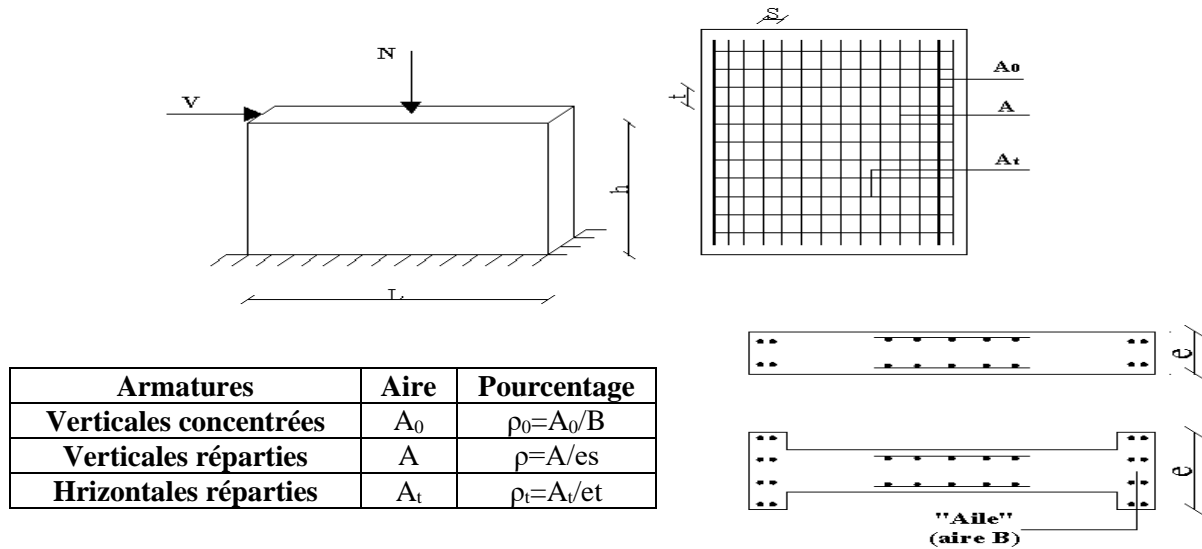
Schéma d'un voile plein et disposition du ferrailage.
